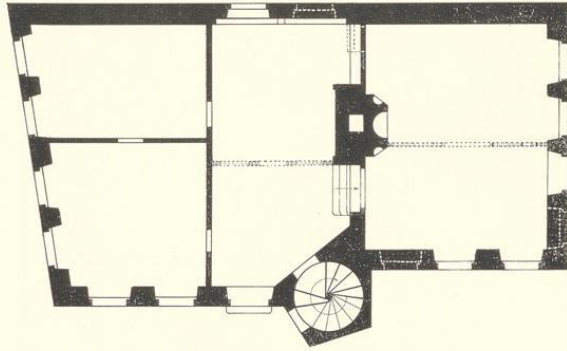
Grundriß des Hauses Krummer Timpen 59; Norden unten
